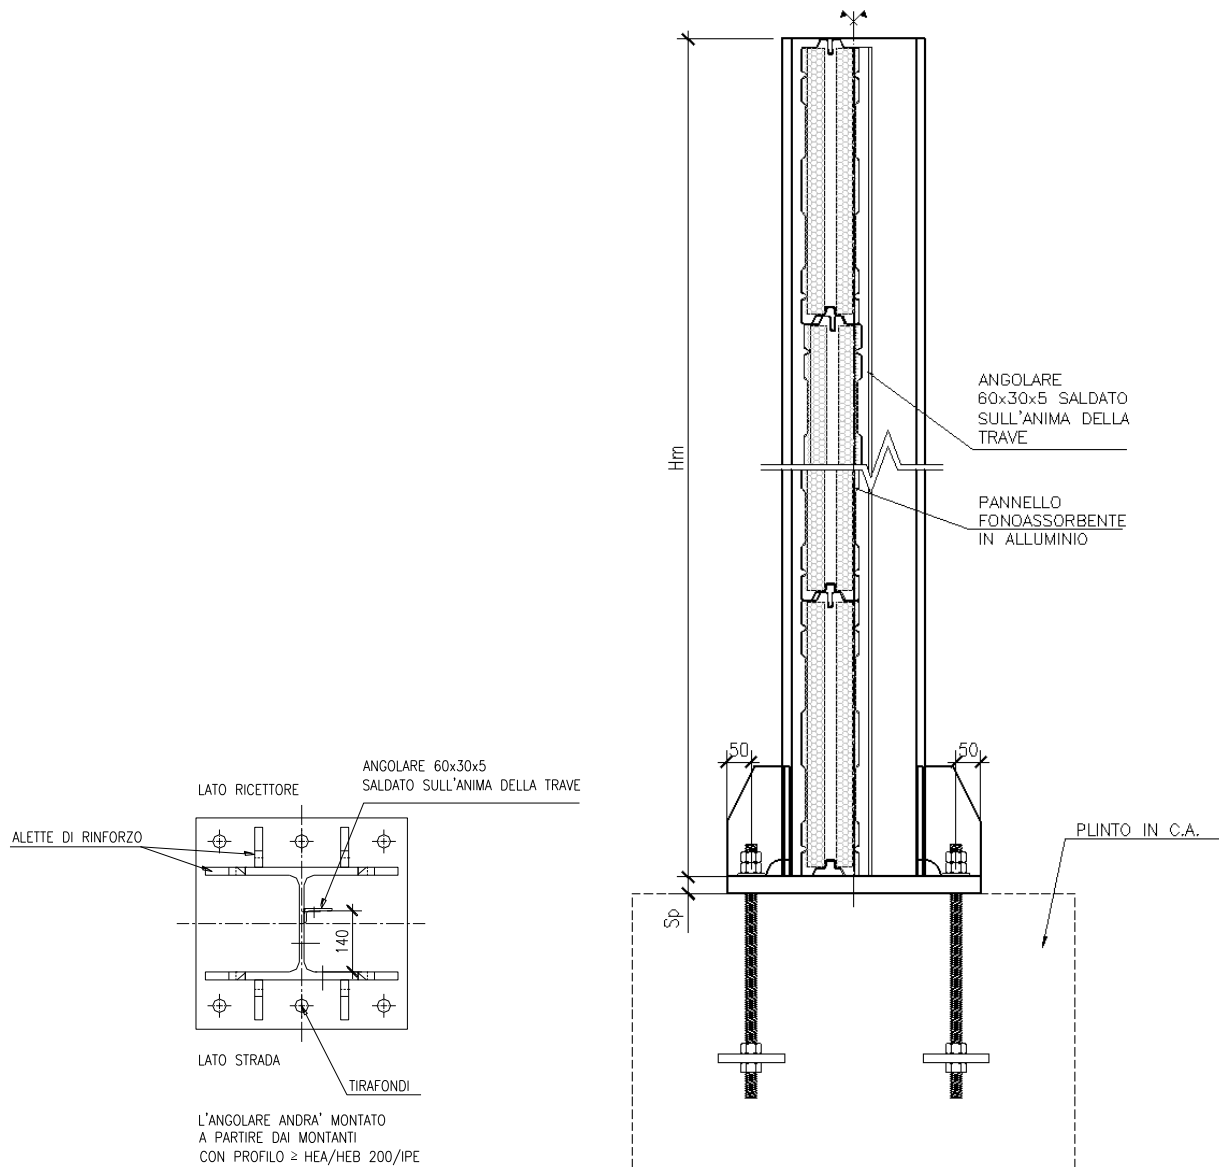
Pianta alla base e sezione verticale architettonici della barriera FOA
